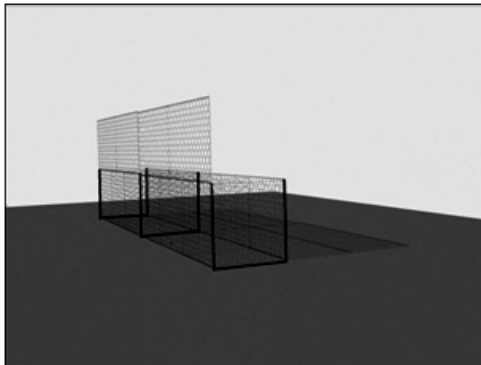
Собранное коробчатое ГСИ с армирующей панелью
